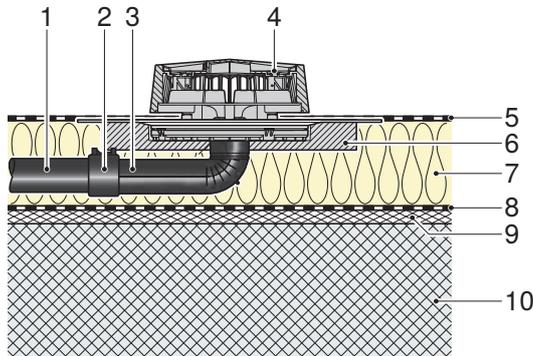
Монтаж на изолированной жесткой кровле с горизонтальным выпуском в тепловой изоляции, кровельным покрытием и пароизоляцией
